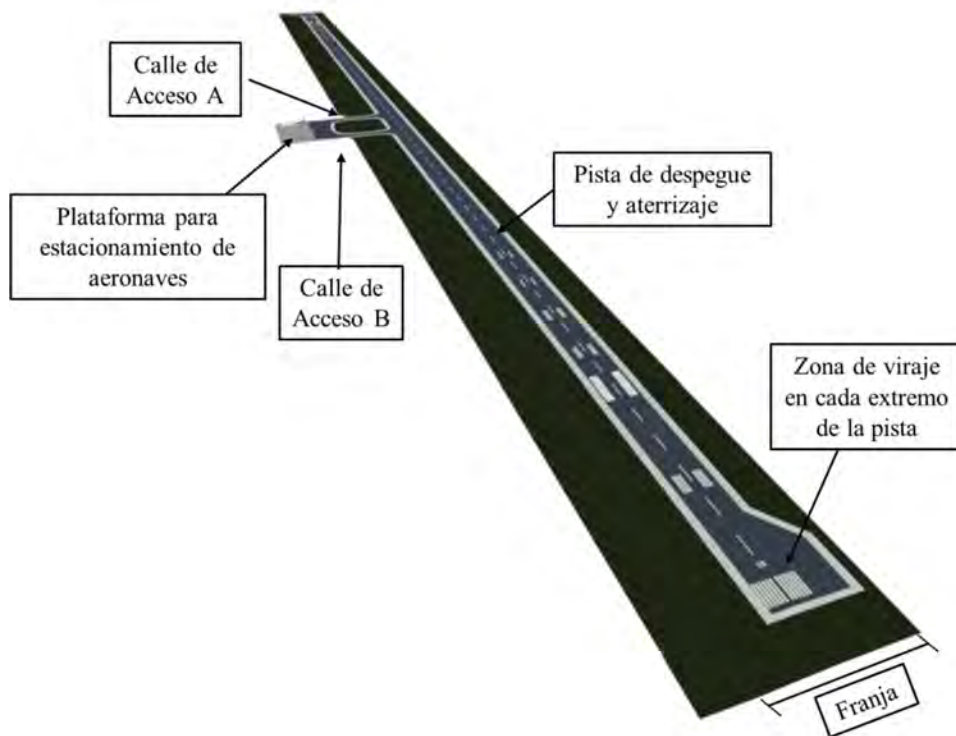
Vista en planta de la nueva geometría modelada del lado aire del aeropuerto
